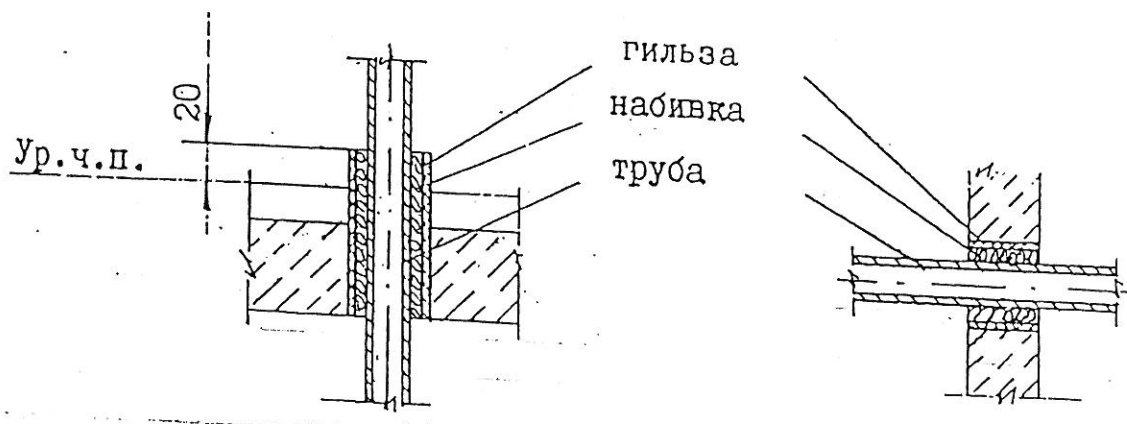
Установка гильзы для прокладки труб в стенах и перекрытиях
